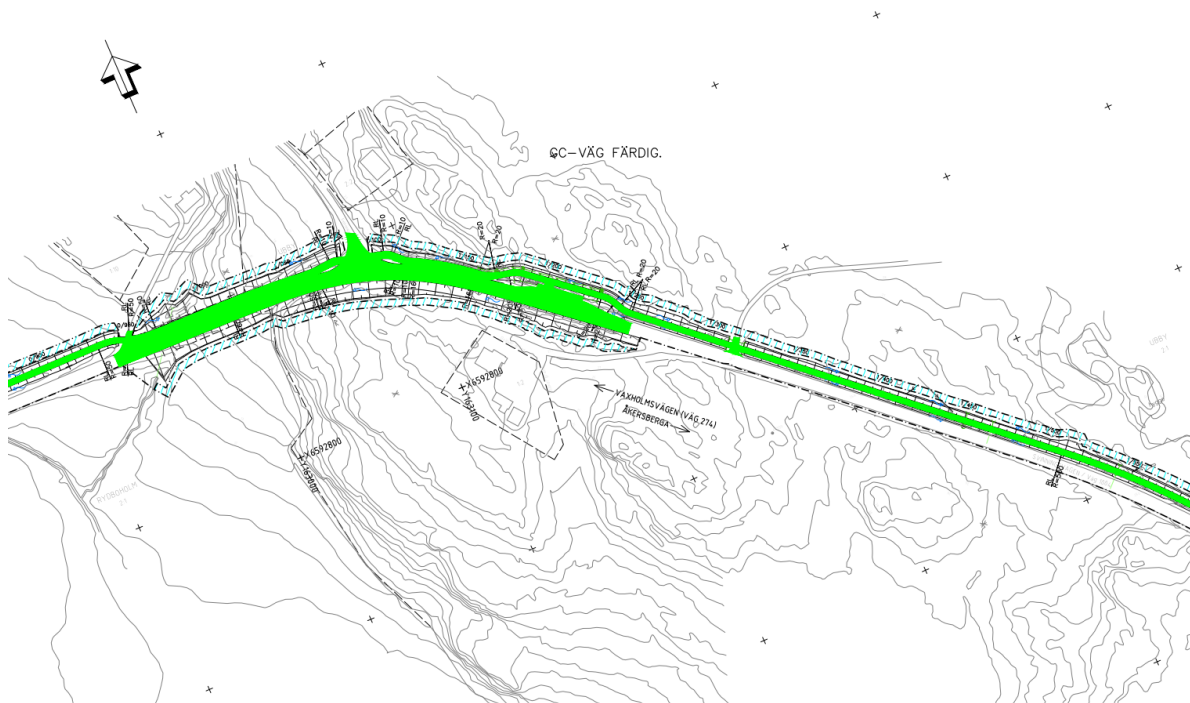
Skedesplan skede 2 TUB B, ritning 100T40B2.
